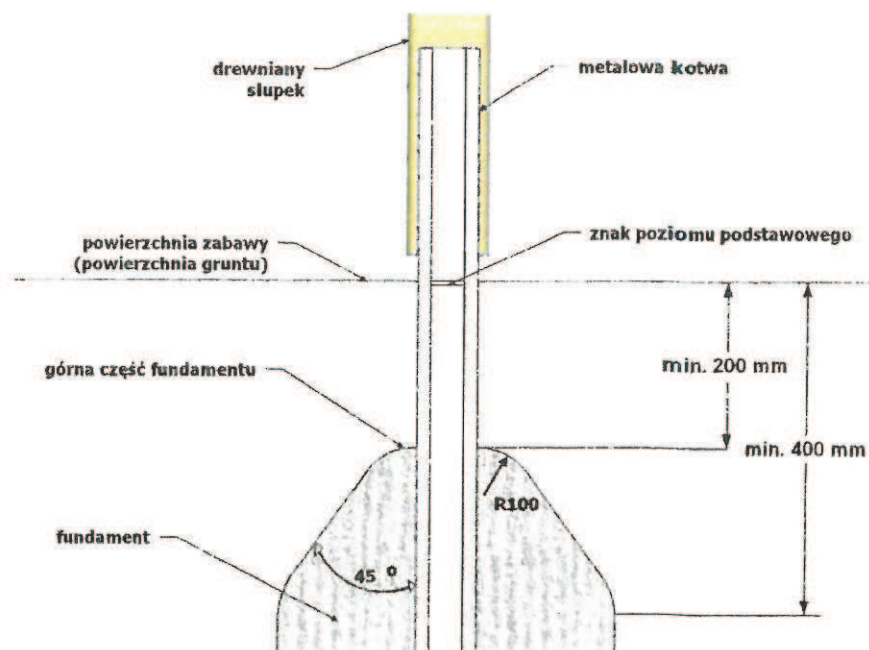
Schemat łączenia elementów konstrukcji drewnianej urządzeń
